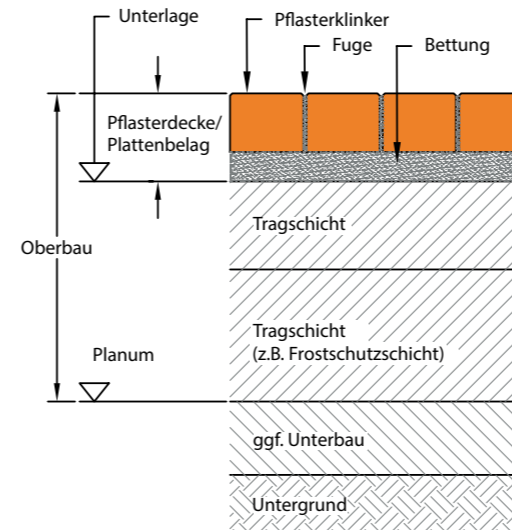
Aufbau einer Verkehrsflächenbefestigung mit Klinkerpflasterdecke gemäß ZTV Pflaster-StB
